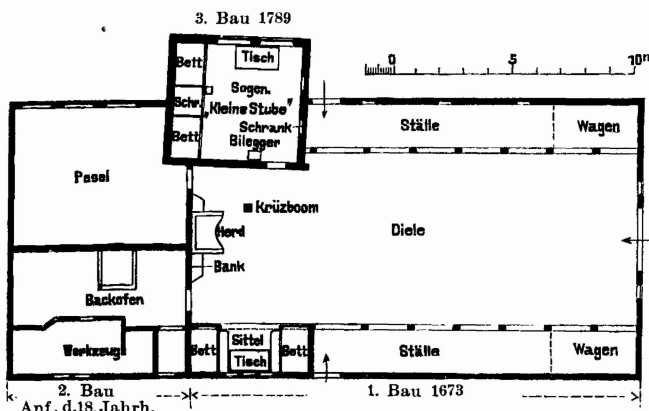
Grundriss des Heldtschen Hauses.
